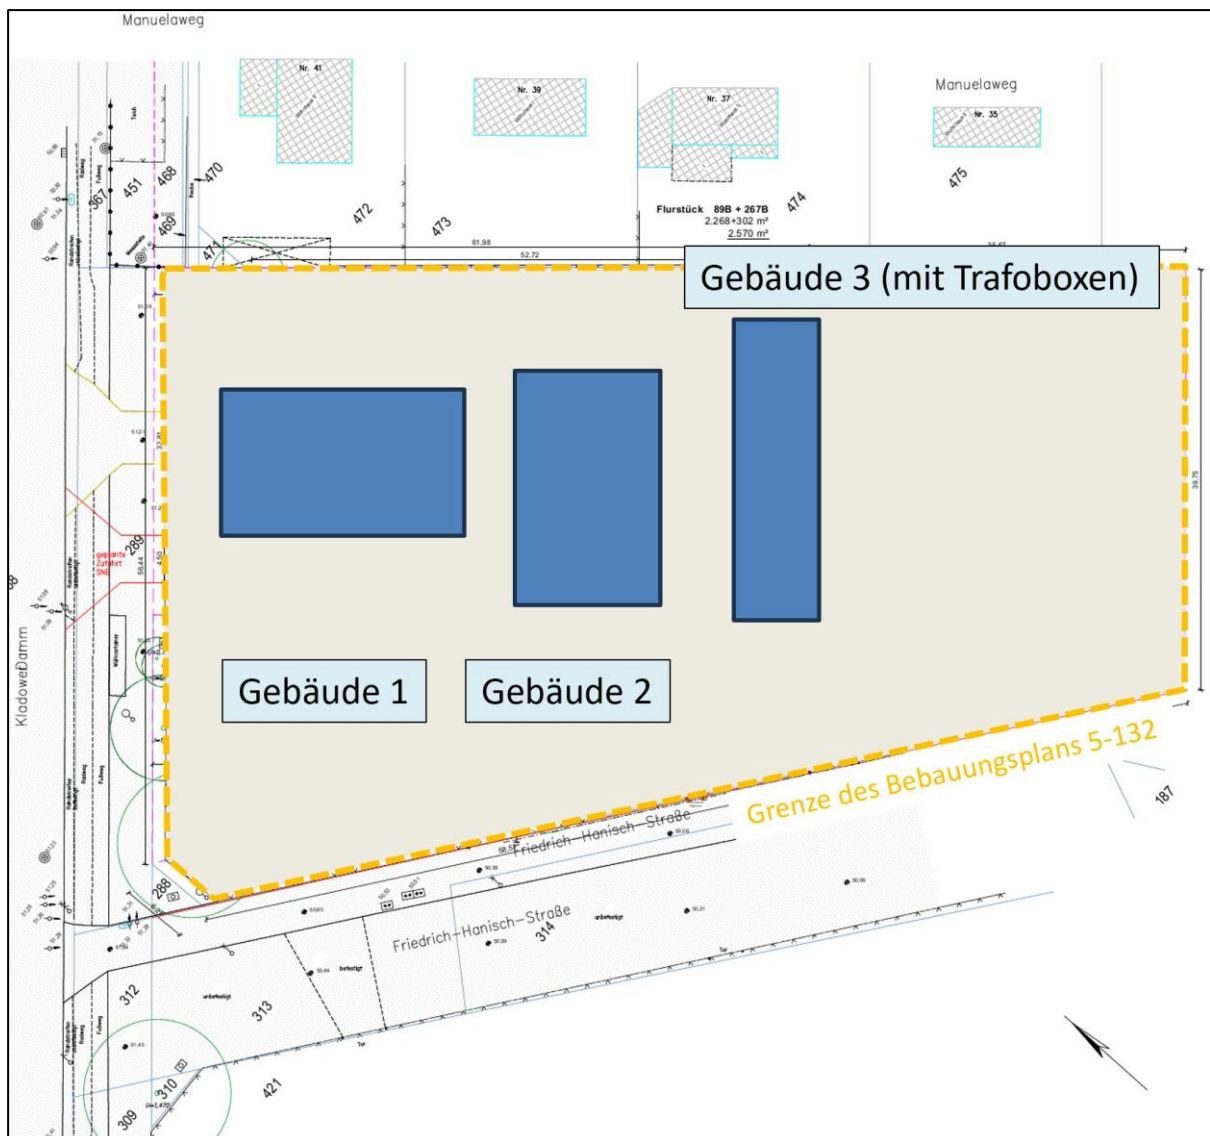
Lageplan eines Entwurfs zum Ersatzneubaus UW KLA und Kennzeichnung der Gebäudeteile
